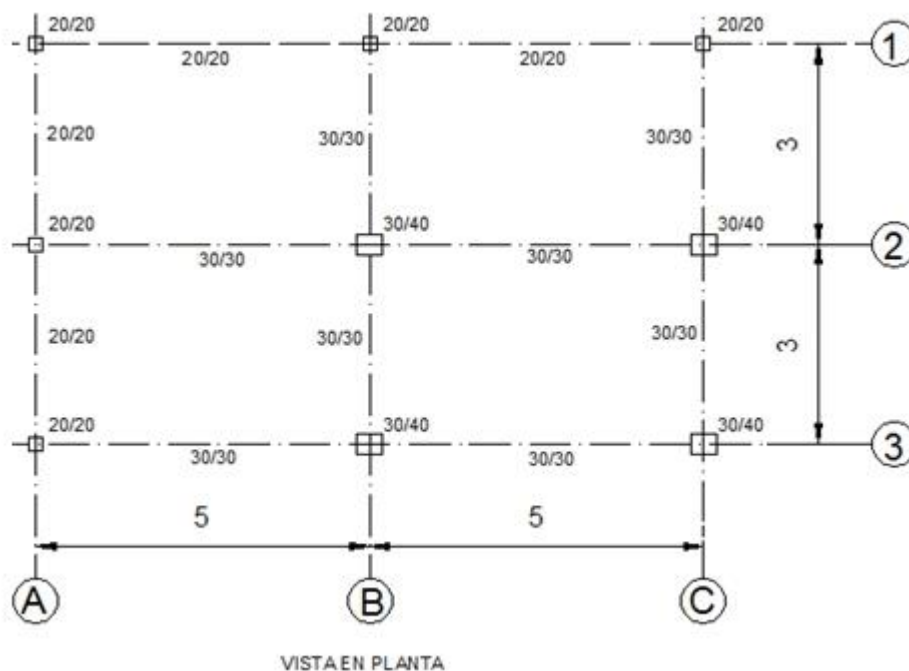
Vista en Planta de una estructura de 1 piso con altura de piso de 3 m.
